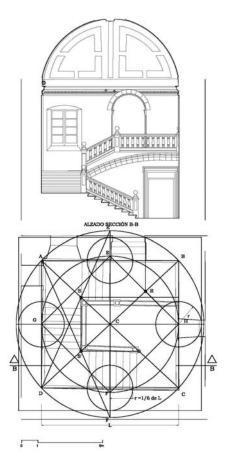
Modulación geométrica de la planta de la escalera (dibujo de la autora)
